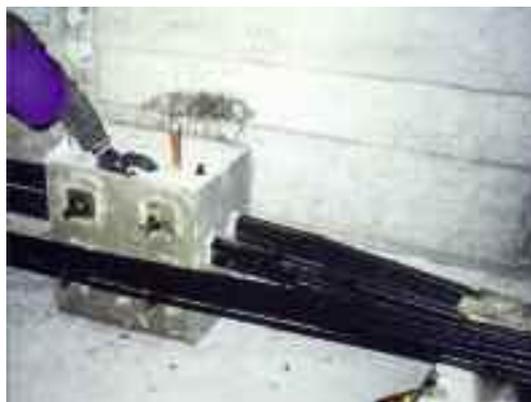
déviateur de type «barillet» (crédit photo CITRA)
